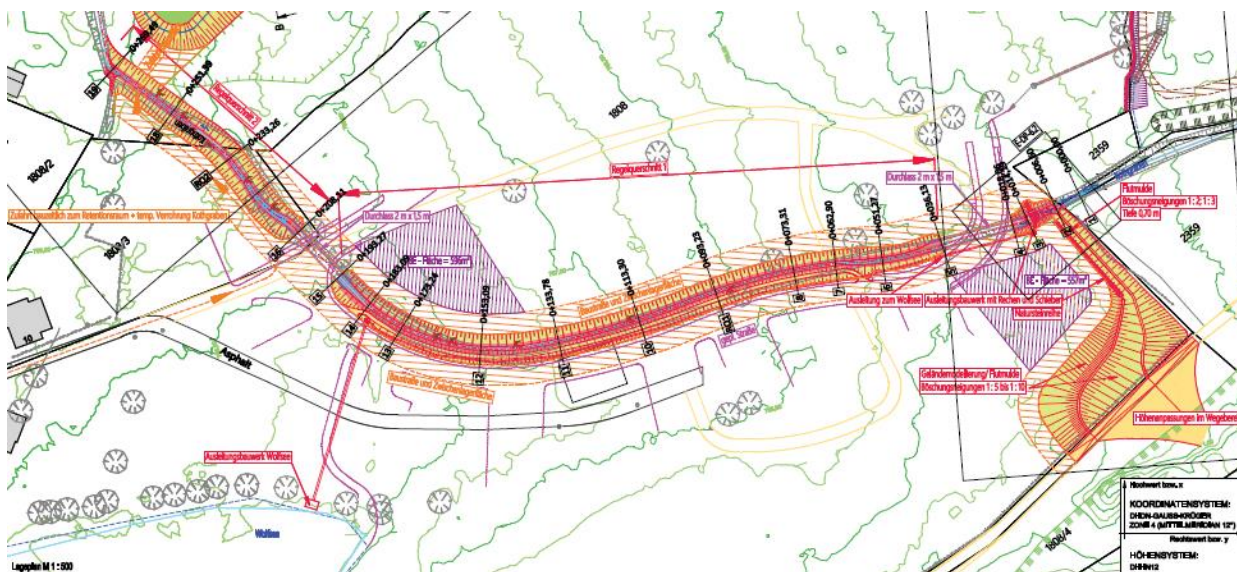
Planauszug – Planungsabschnitt Gewässerausbau Kothgraben.
